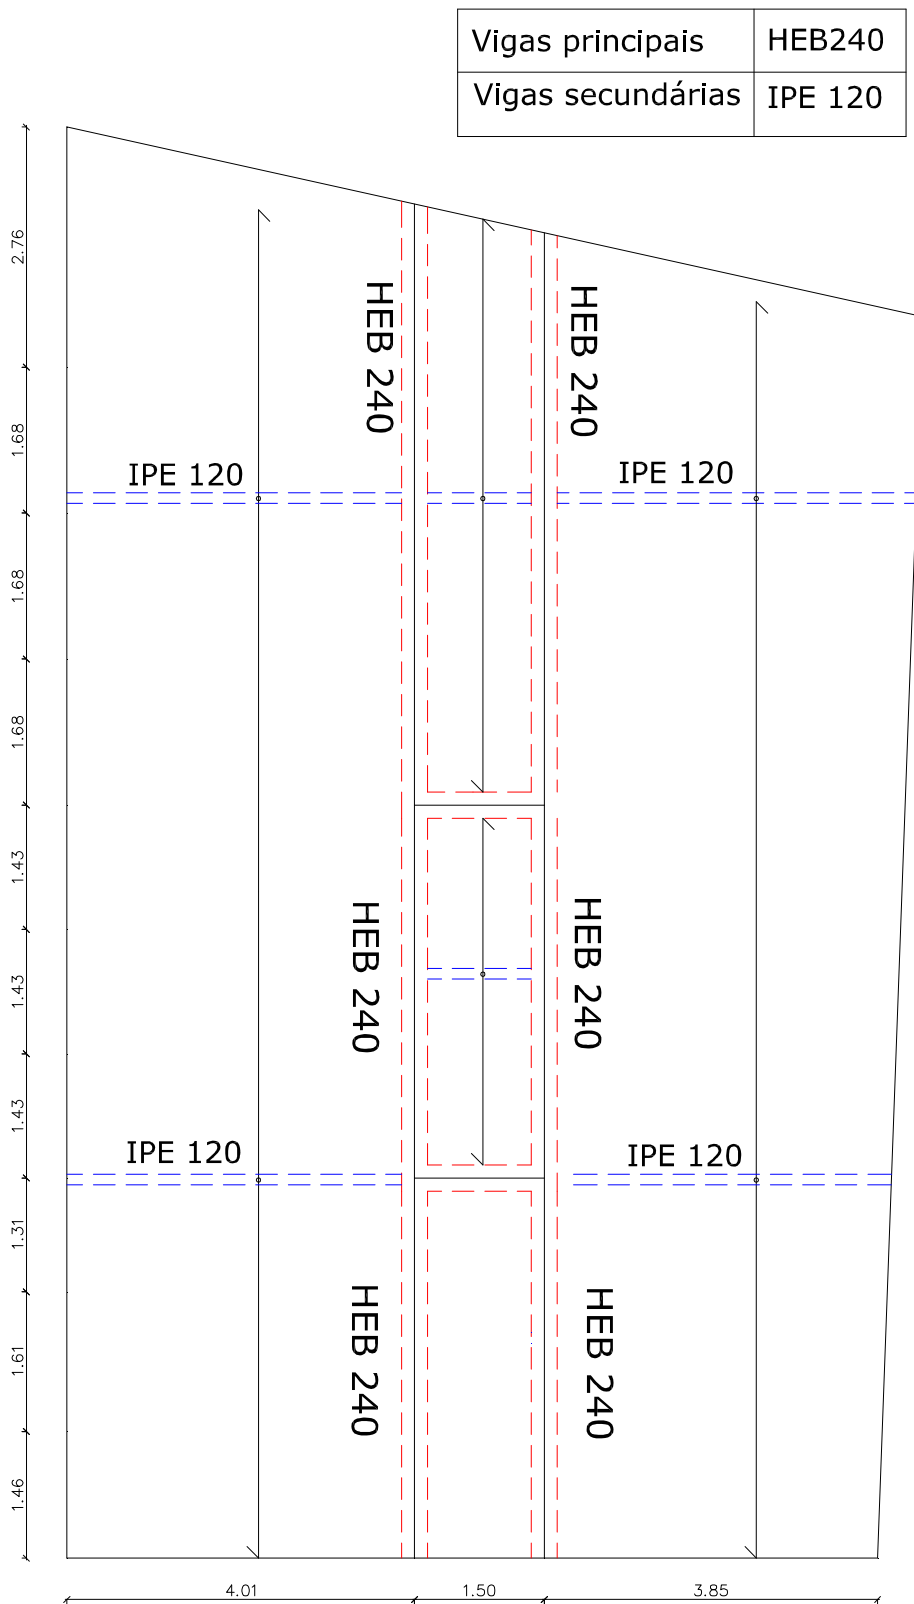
Localização em planta dos perfis metálicos a aplicar no pavimento do sótão
